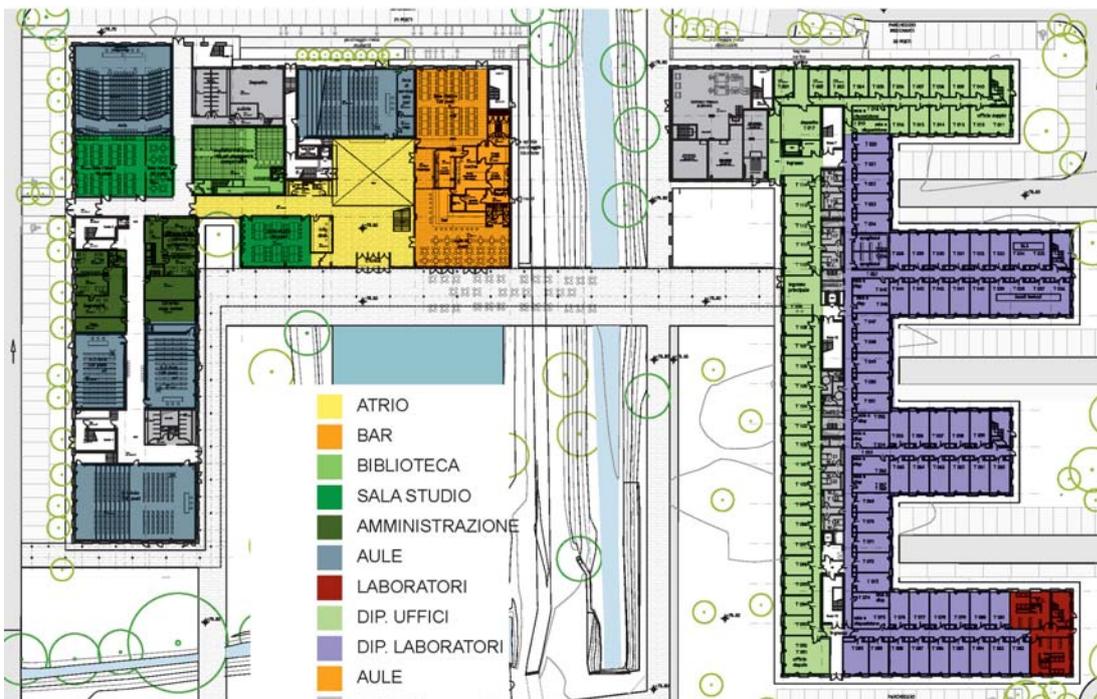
Pianta piano terra Lotto 1-2 e identificazione funzionale
